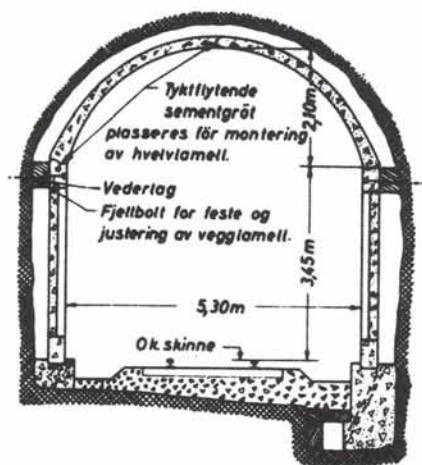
Tverrsnitt av tunnelutforing med betonglameller.
